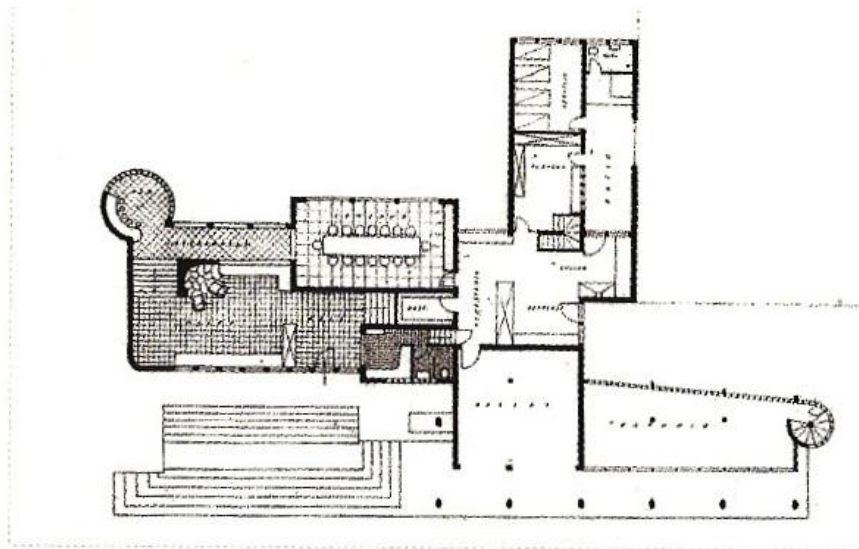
Direktorhaus an der Universitätsstadt, Grundriss.
